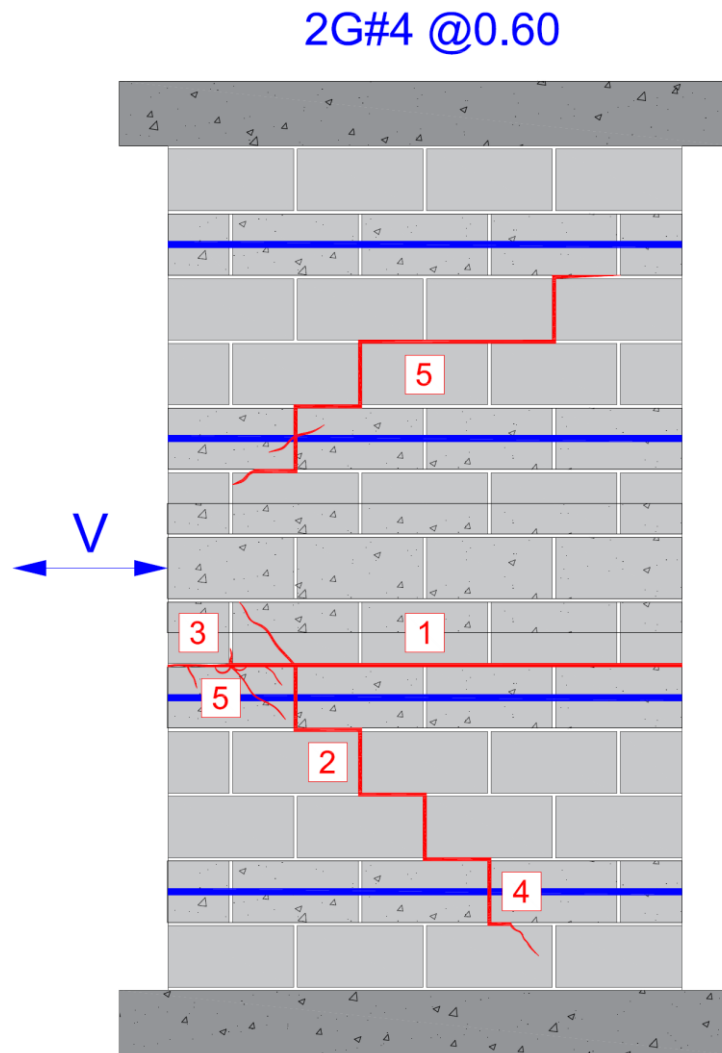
Fisuración y modo de falla del muro MC-2#4/60
